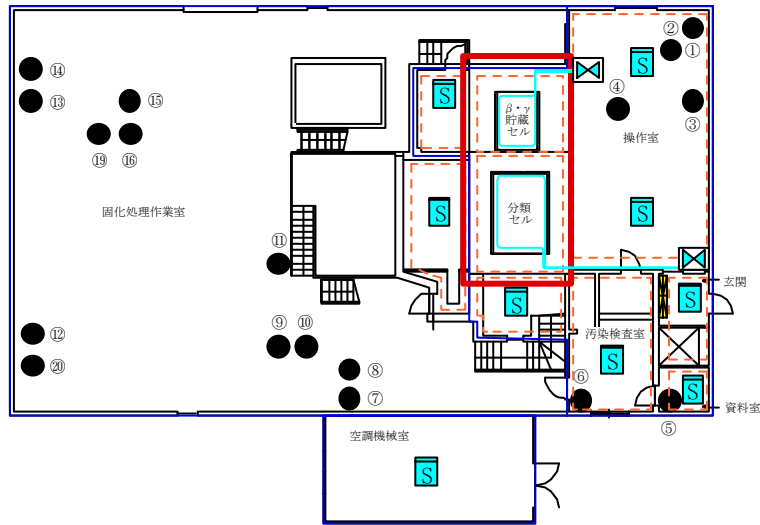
β・γ 固体処理棟Ⅲ 2階及び中2階平面図及び可燃物配置図
